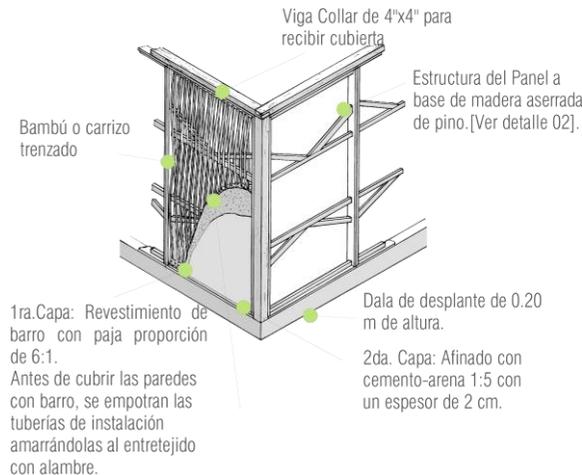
Detalle constructivo de un muro de bahareque prefabricado. NMG.
